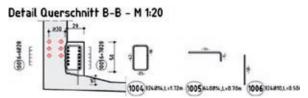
Querschnittsergänzung mit Betonstahlbewehrung zur Verbesserung des Ankündigungsverhaltens Zeichnung: aus [32]
